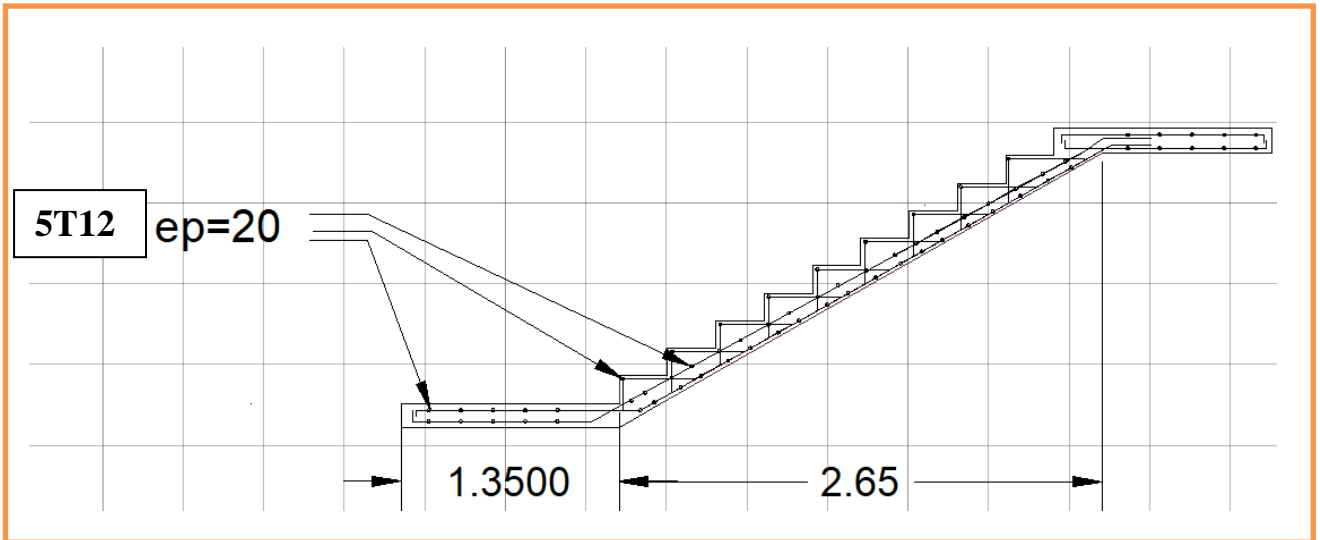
schéma de ferrailage de la première volée (RDC).
